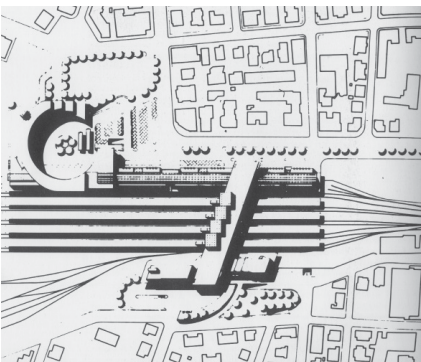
Planivolumetrico del progetto per la nuova stazione in un'ipotesi di struttura a ponte tra centro e zona mare. Immagine da: Cautiero, Tonti, 1992, p. 65.
